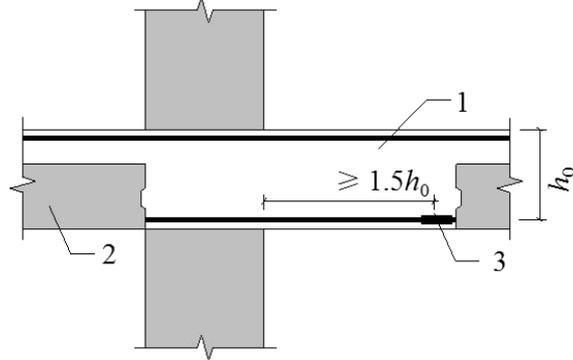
梁纵向钢筋在节点区外的后浇段内连接示意
